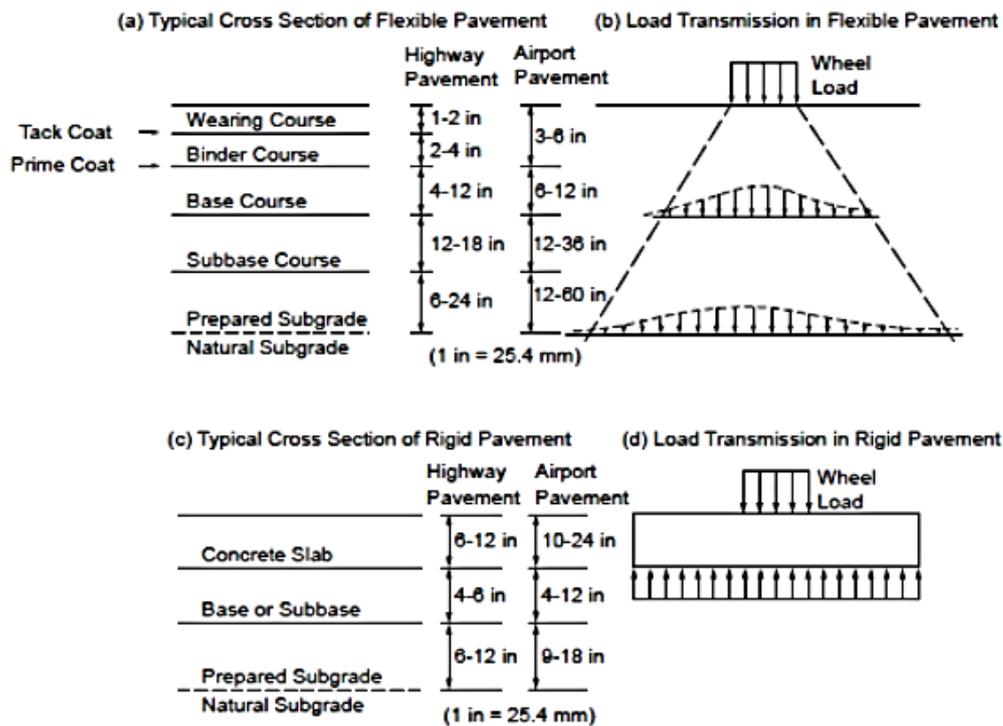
Transmisión de esfuerzo en pavimento flexible y rígido
